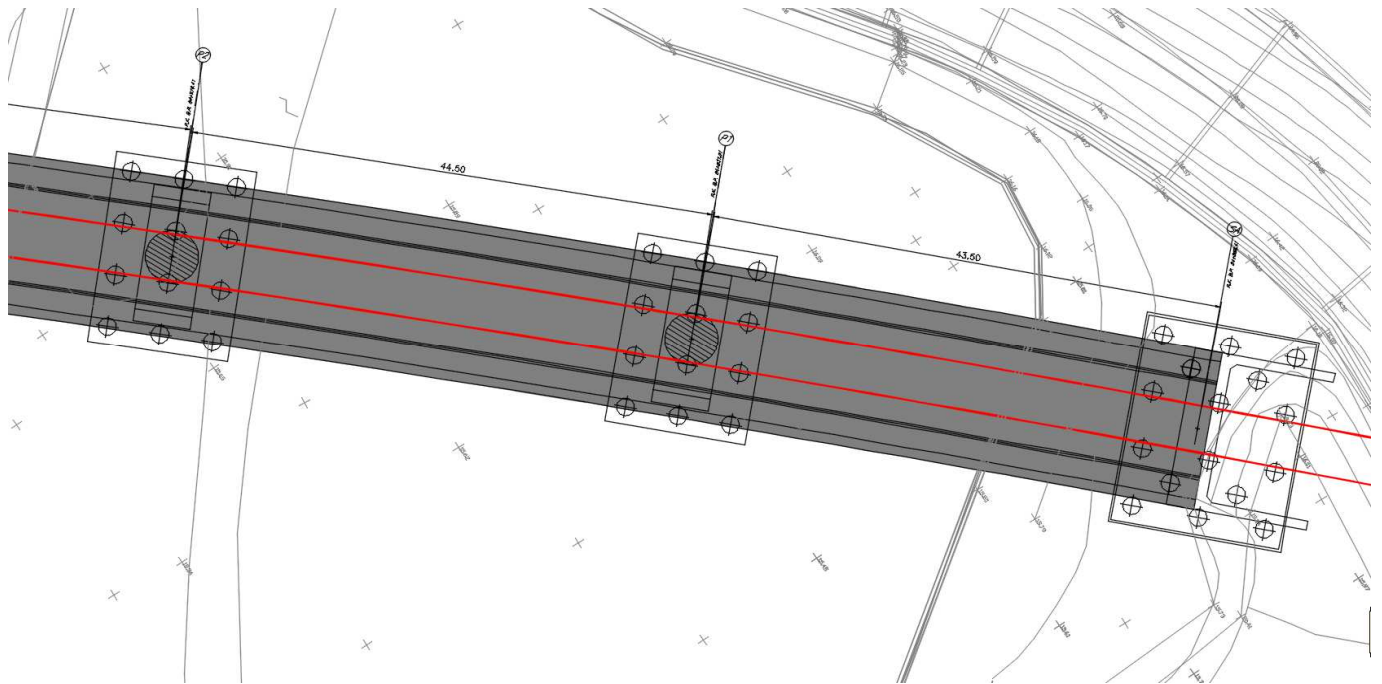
planimetria generale tra Pila2 e Spalla A
